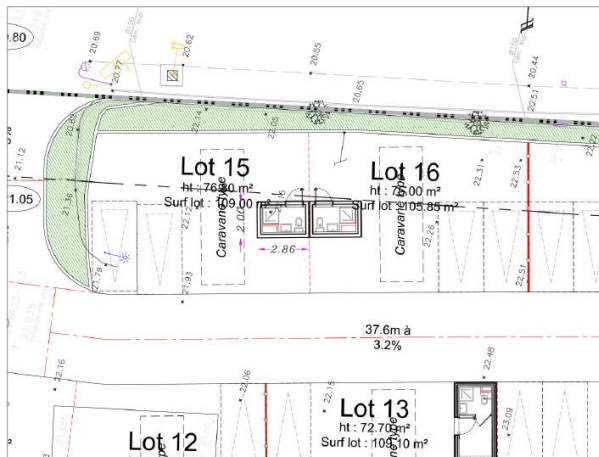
Caractéristiques des lots non conformes au décret (Source : Plans d'Avant-projet – Agence d'architecture SPAGNOLO)
